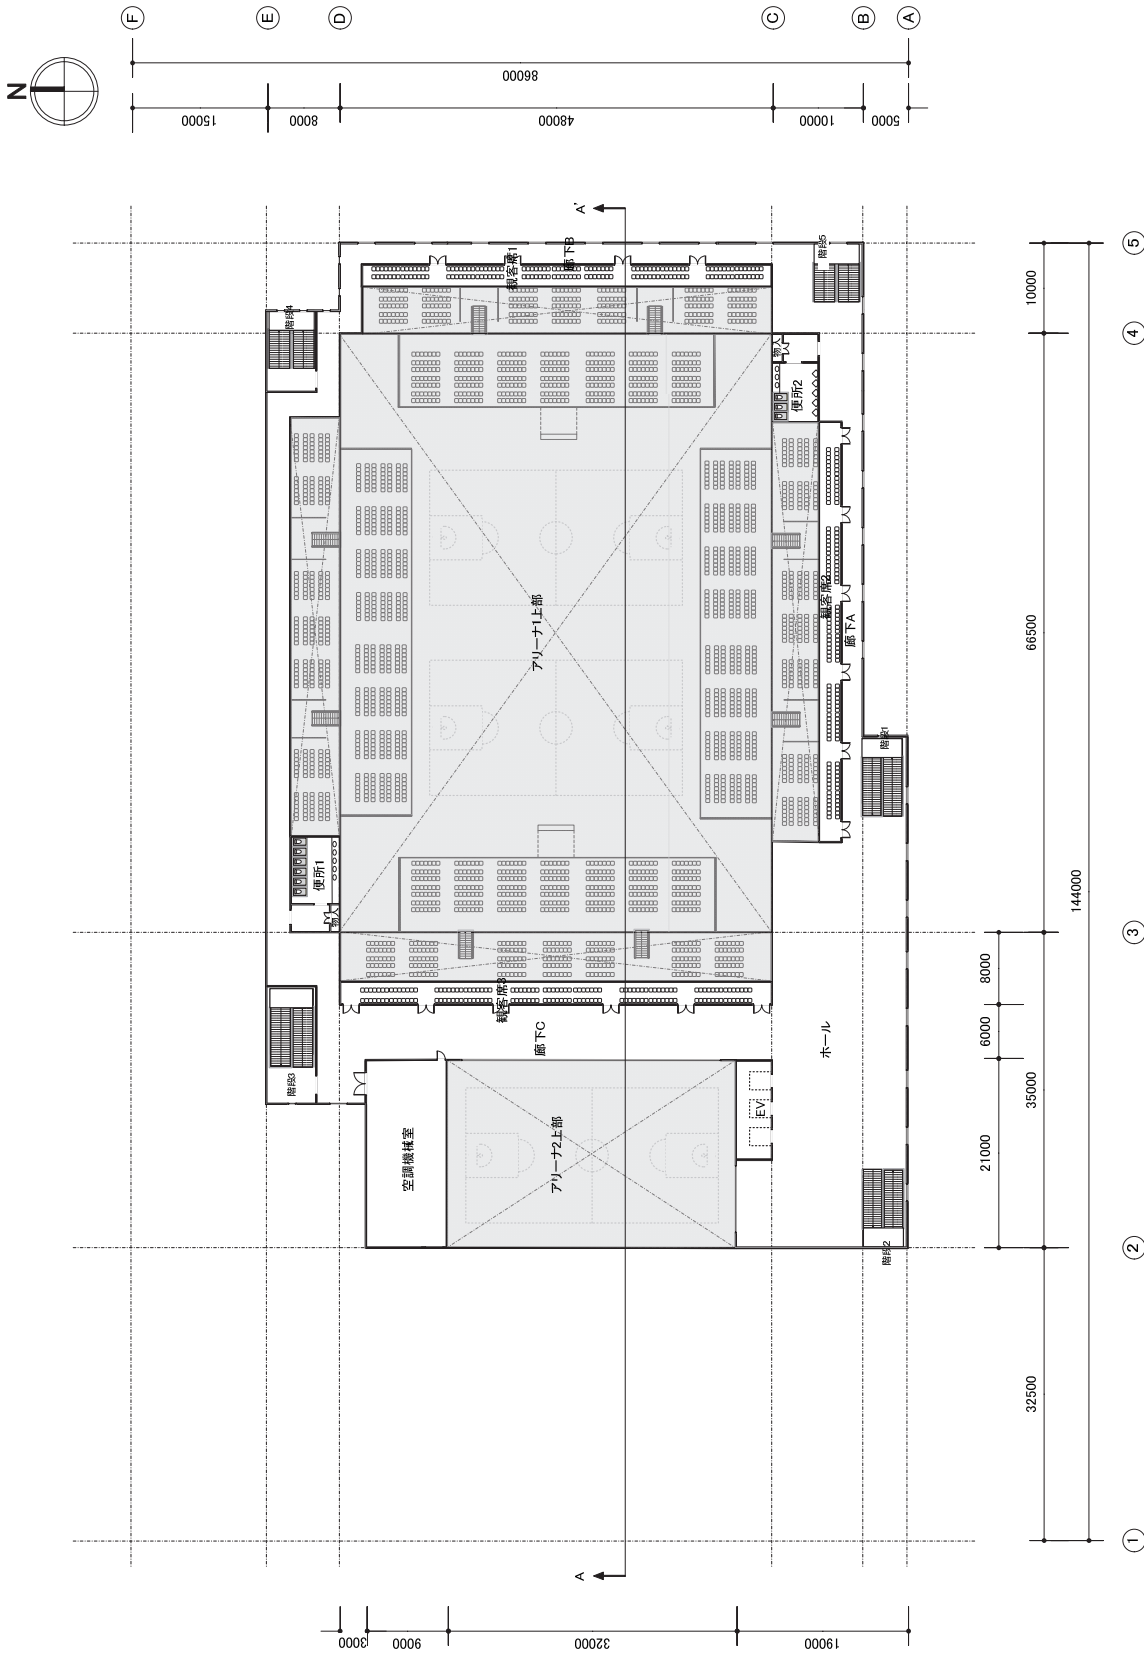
A.34 モデル建物 (集会所等・体育館、10,000㎡) 3階平面図
